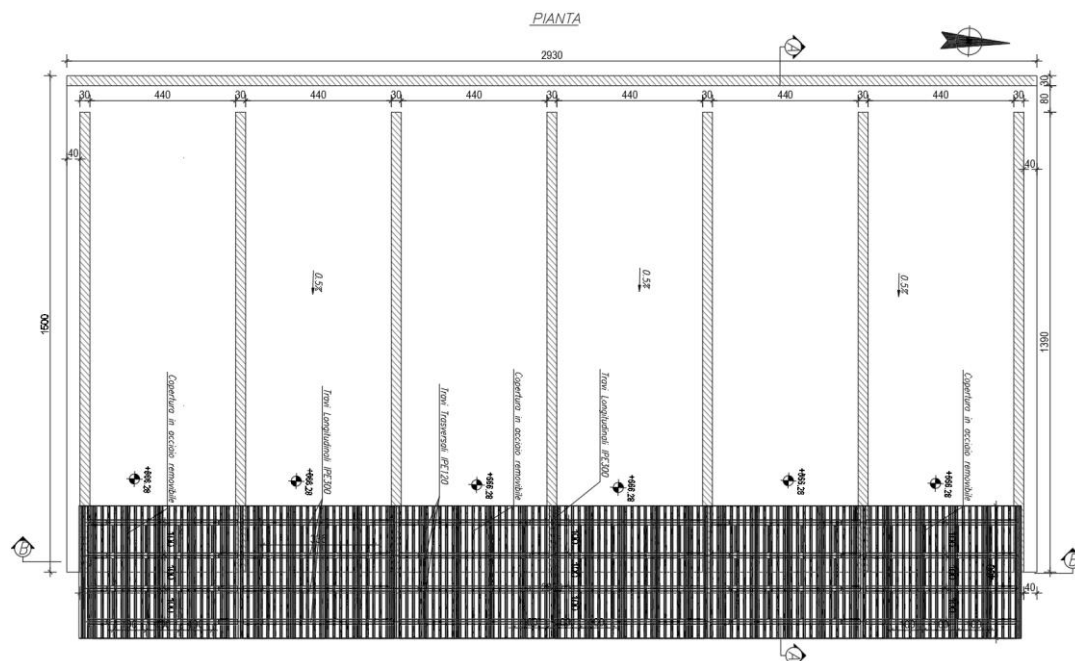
PIANTA muri serbatoi stoccaggio H2
